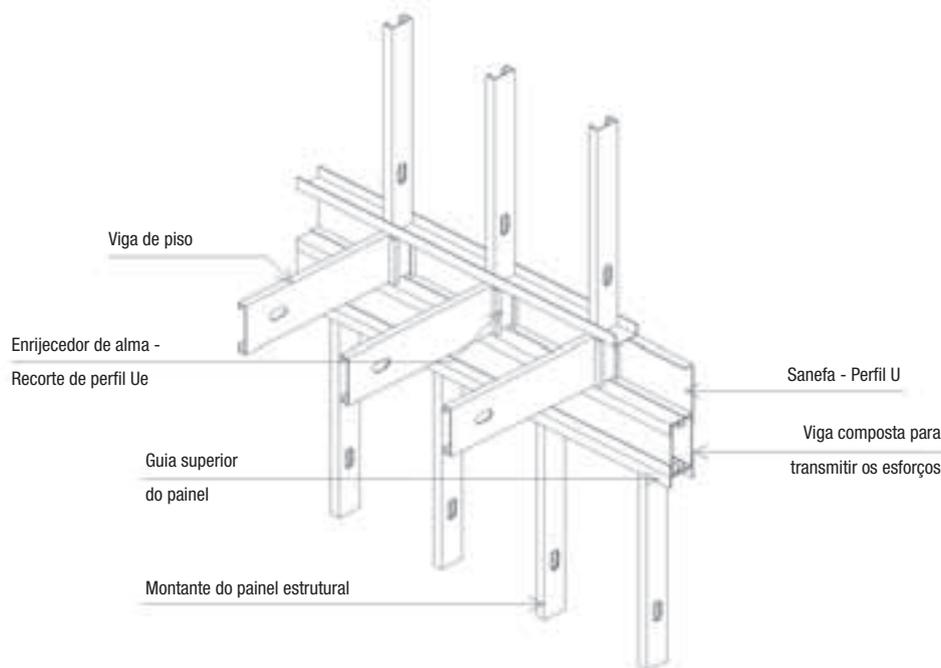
Viga de distribuição da carga do piso para os montantes
